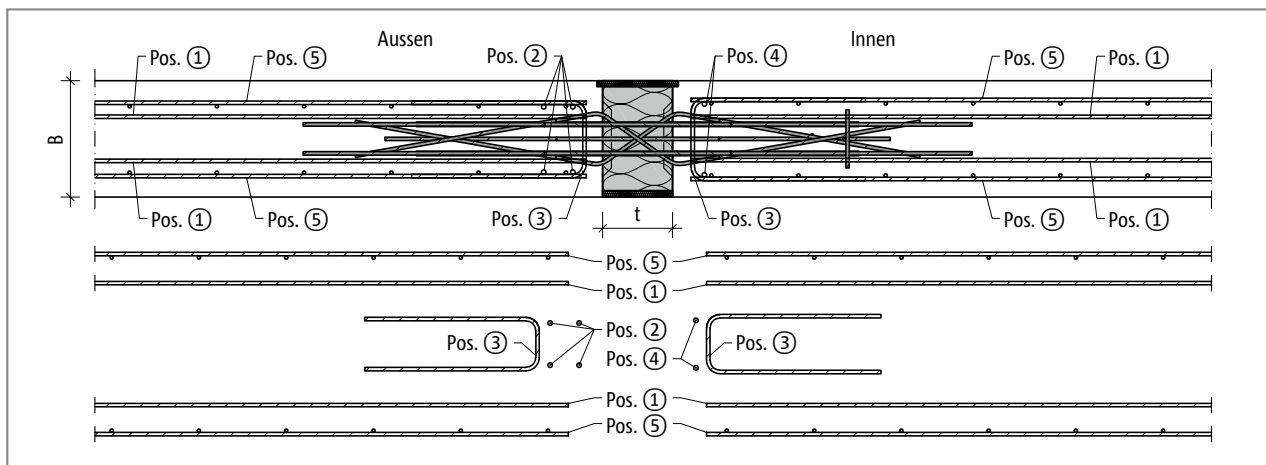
Schöck Isokorb® XT Typ WL: Bauseitige Armierung; Grundriss
